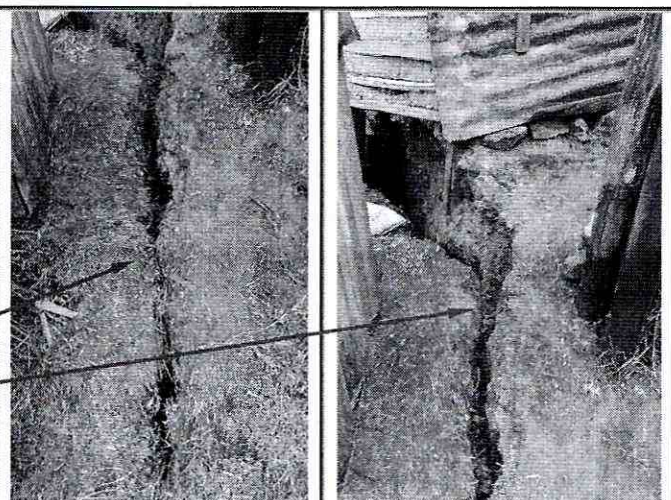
y 8. Se observan algunas grietas de tracción con aberturas cercanas a los 10 cm, comprometiendo la cimentación de la vivienda.
